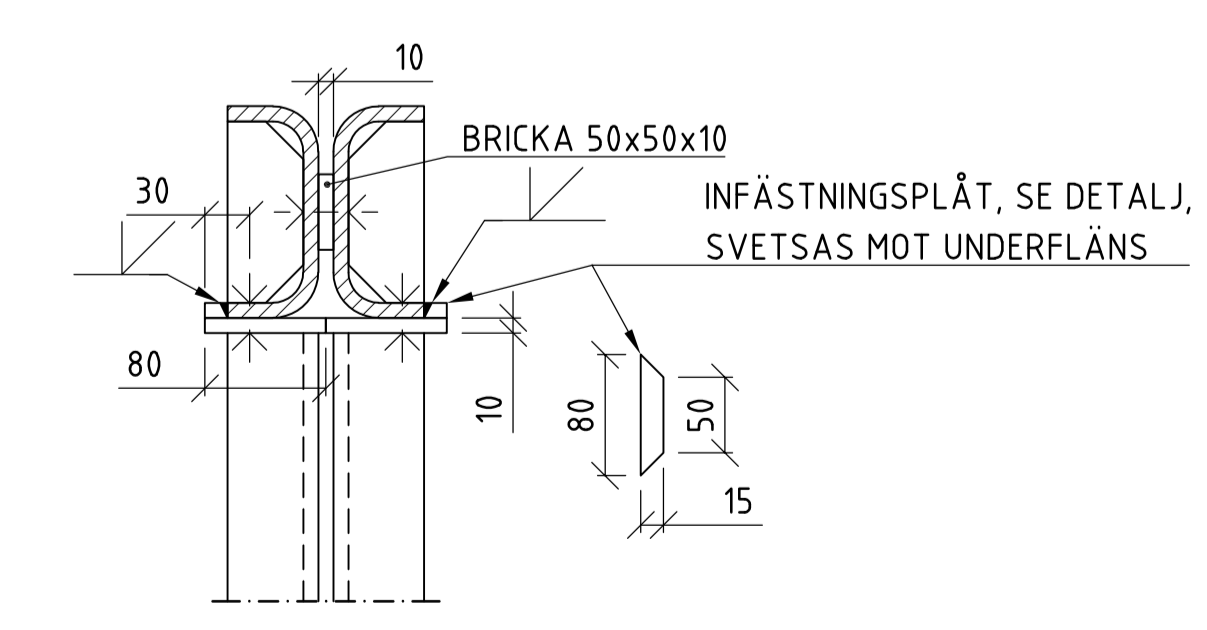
ALTERNATIV UTFORMNING, 1:5
